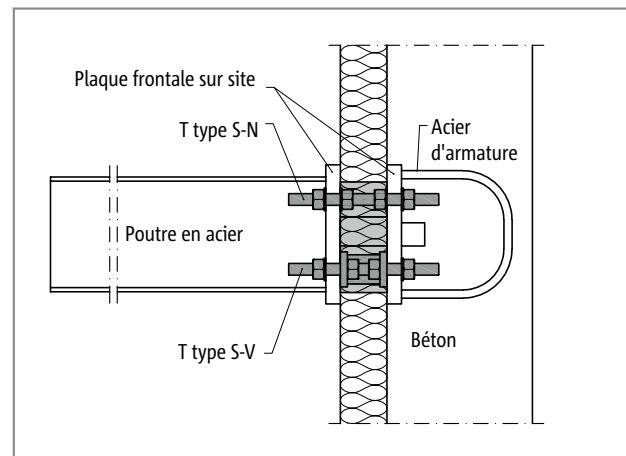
Schöck Isokorb® T type S-N et T type S-V : raccordement de structure en acier sur béton
